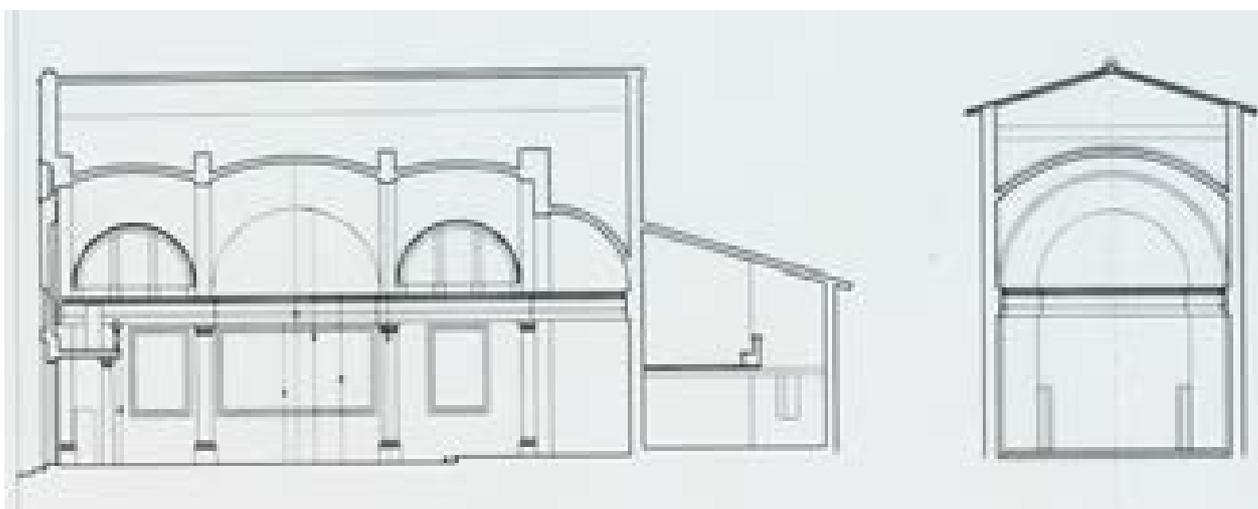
Sezioni – Stato attuale – Bruno Sacchi – 10/06/2003 (AABS-94.210)
